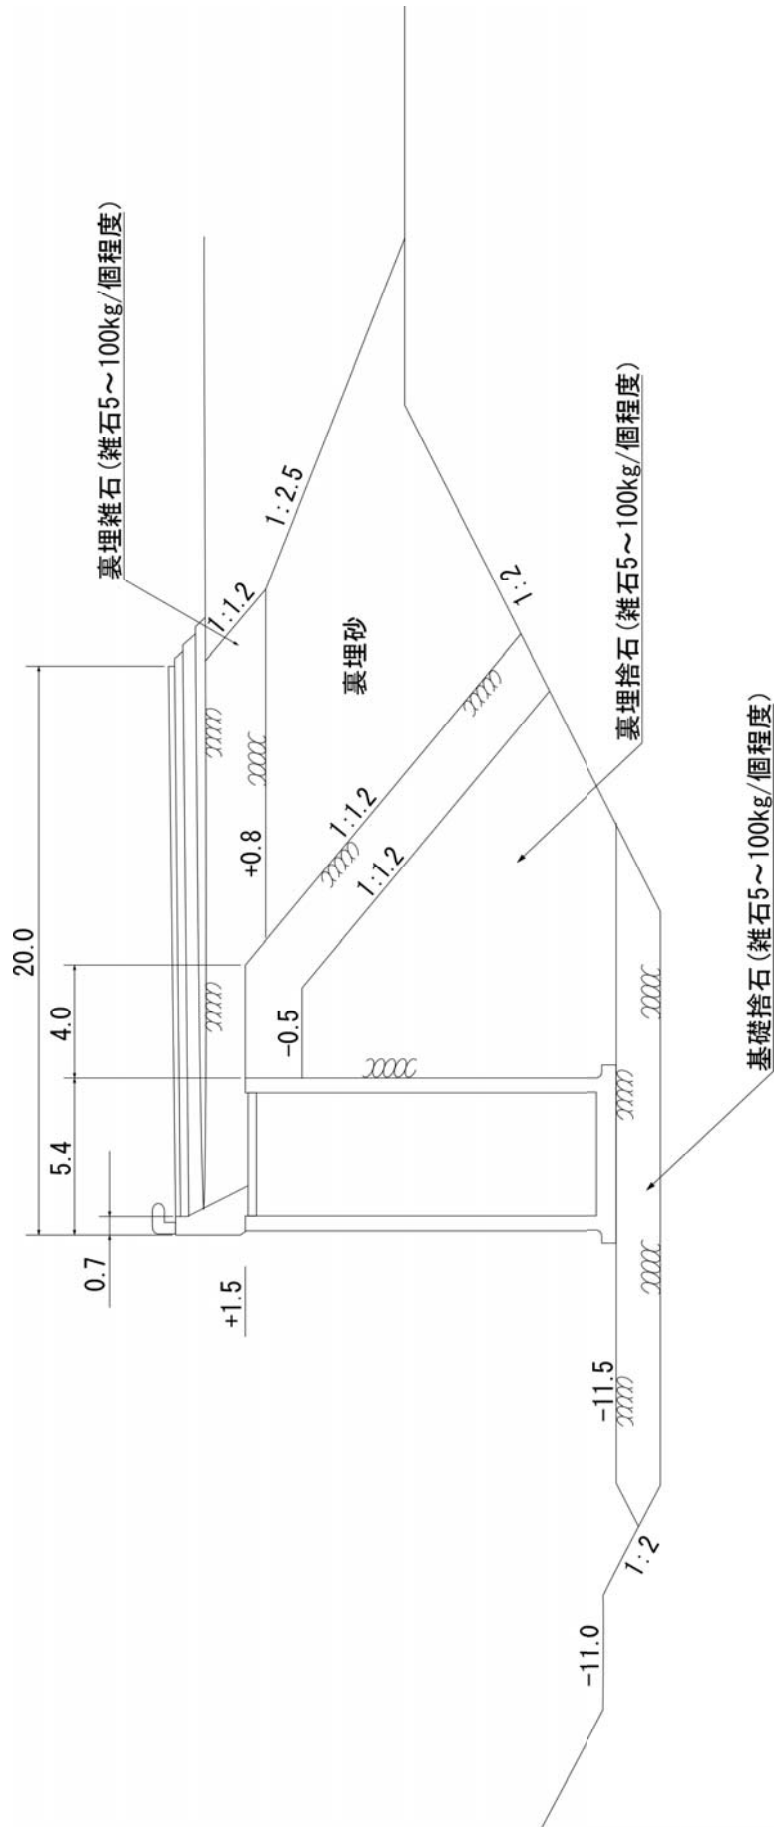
アイランドシテイ地区-11m 岸壁の標準断面図
